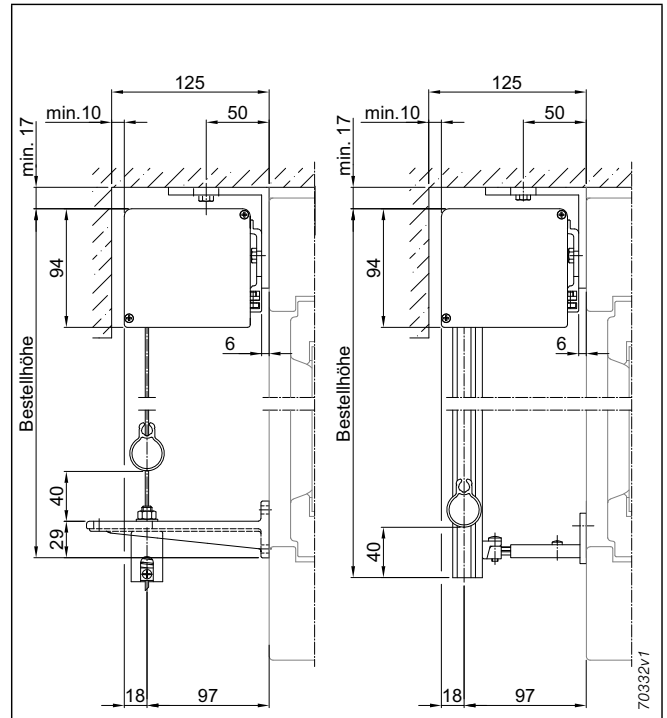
Senkrecht-Markise 490, Deckenmontage
